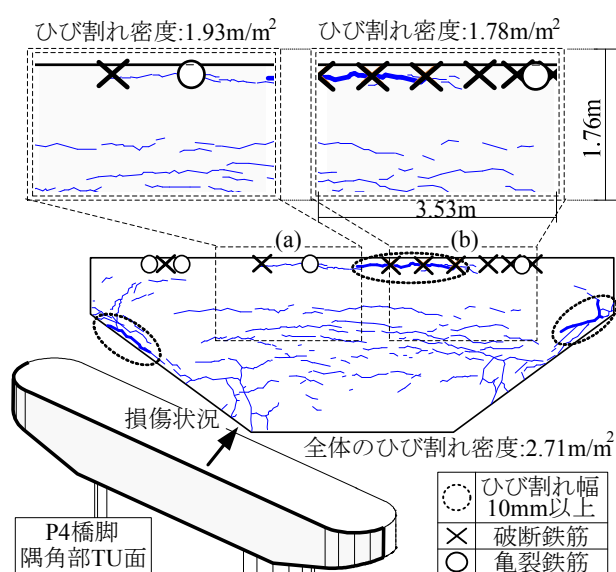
ひび割れ状況と鉄筋損傷状況の比較 (P4)
